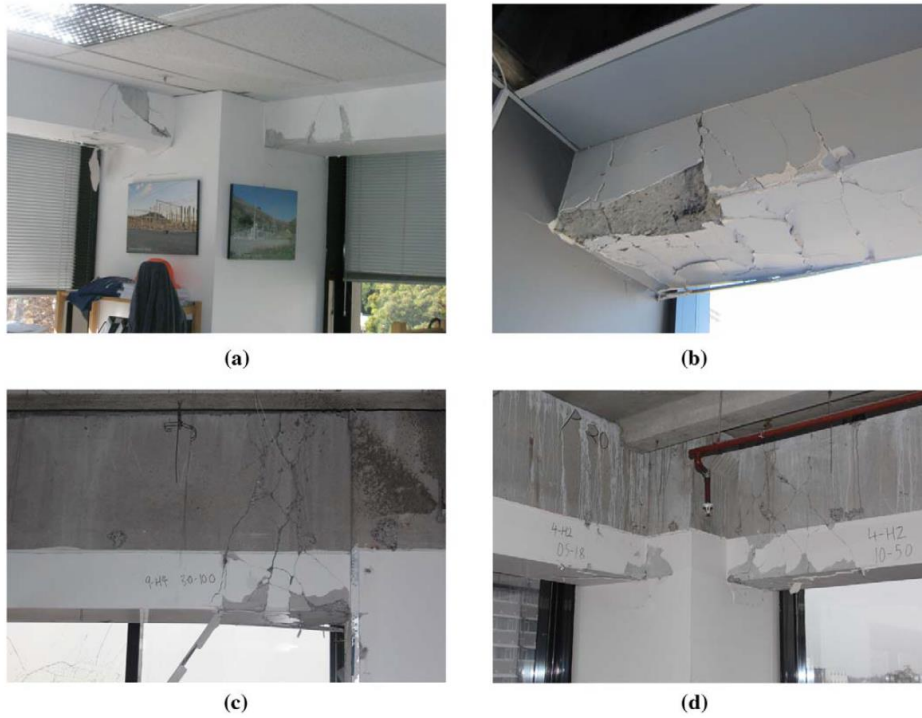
Daños en vigas, debido al desarrollo de rotulas plásticas. (a) columna de esquina; (b) Perdida de recubrimiento; (c) grietas en vigas interiores; (d) grietas en vigas de esquina.
